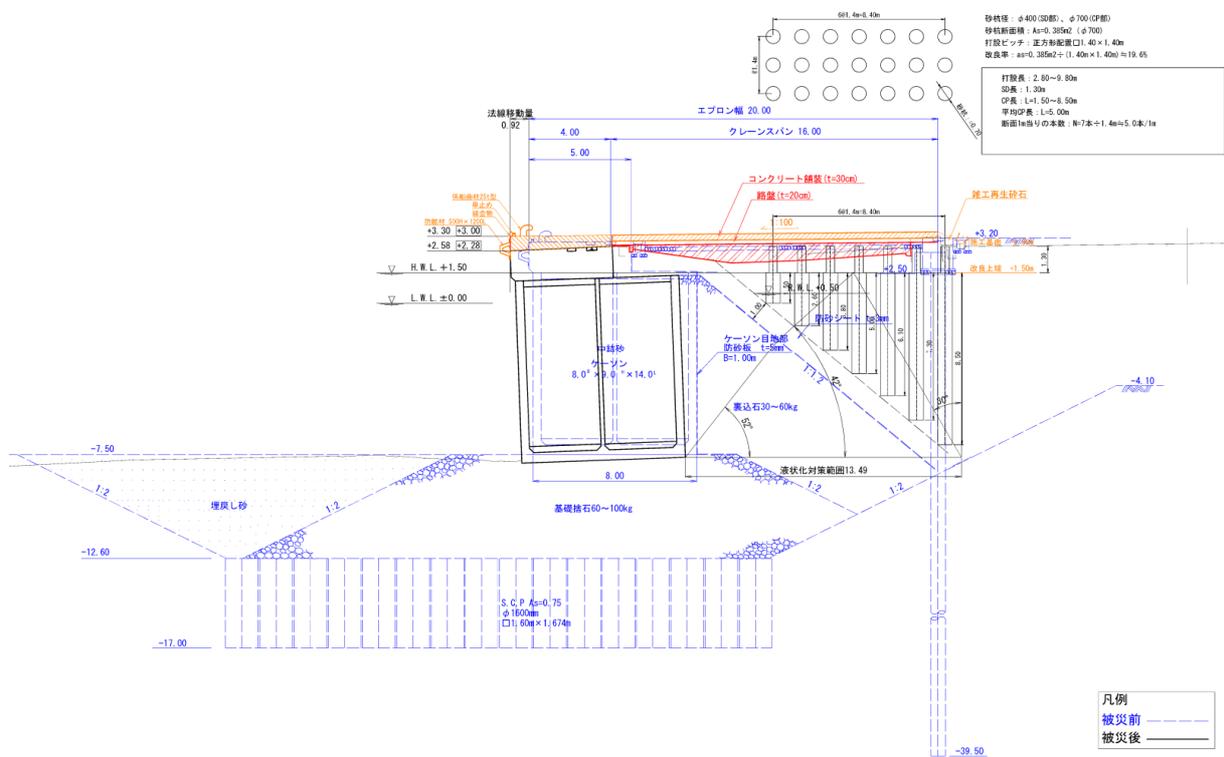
No.9 日立港区第4埠頭地区 4-C 岸壁 (-7.5m) の断面図 (復旧後)
